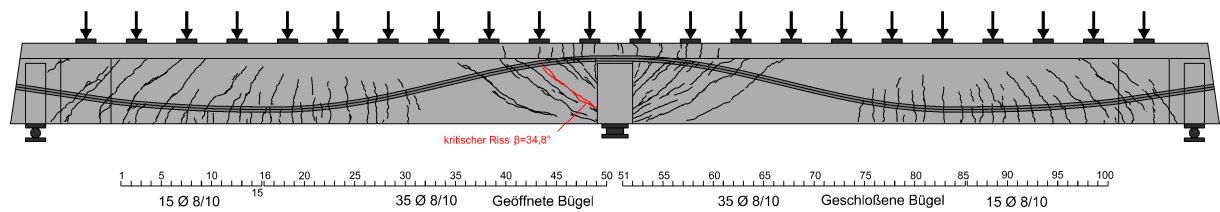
Rissbilder des Versuchsträgers DLT 8 für ausgewählte Laststufen
